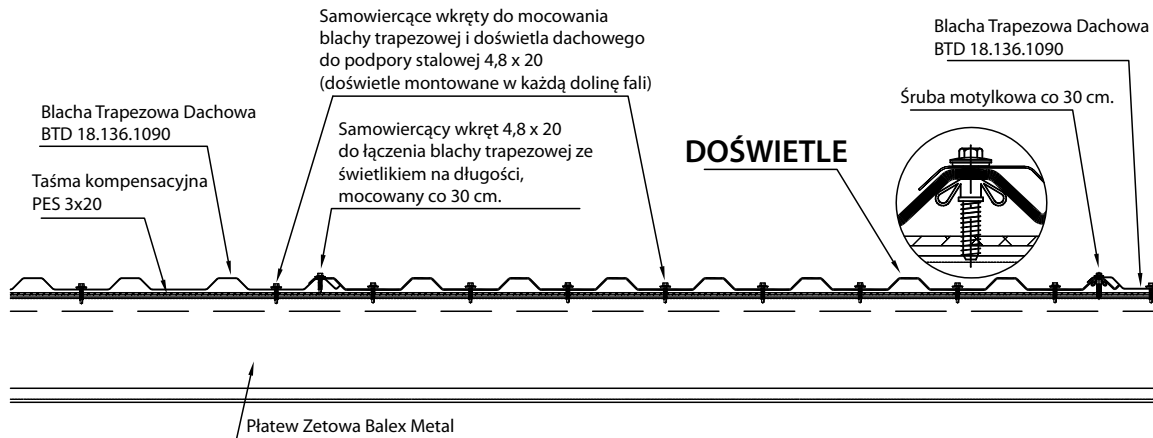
Sposób montażu doświetli dachowych na blachach trapezowych.
